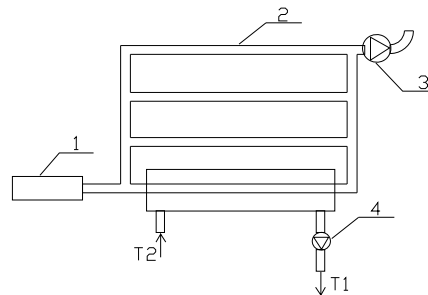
Принципова схема повітряно-водяної системи теплопостачання з трубчастими газовими нагрівачами / Principal scheme of air-water supply system with tube gas heaters:
